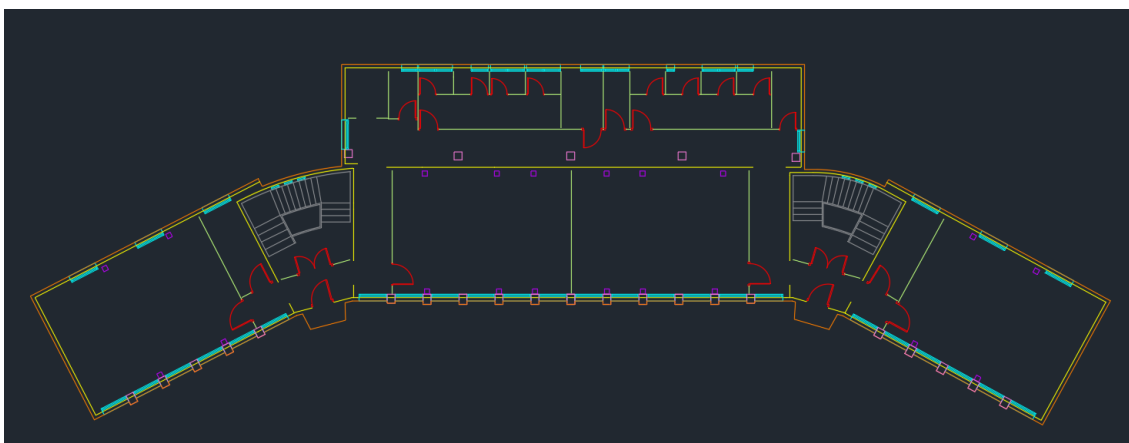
Plano de la planta 1 revisado adaptado para CYPE
